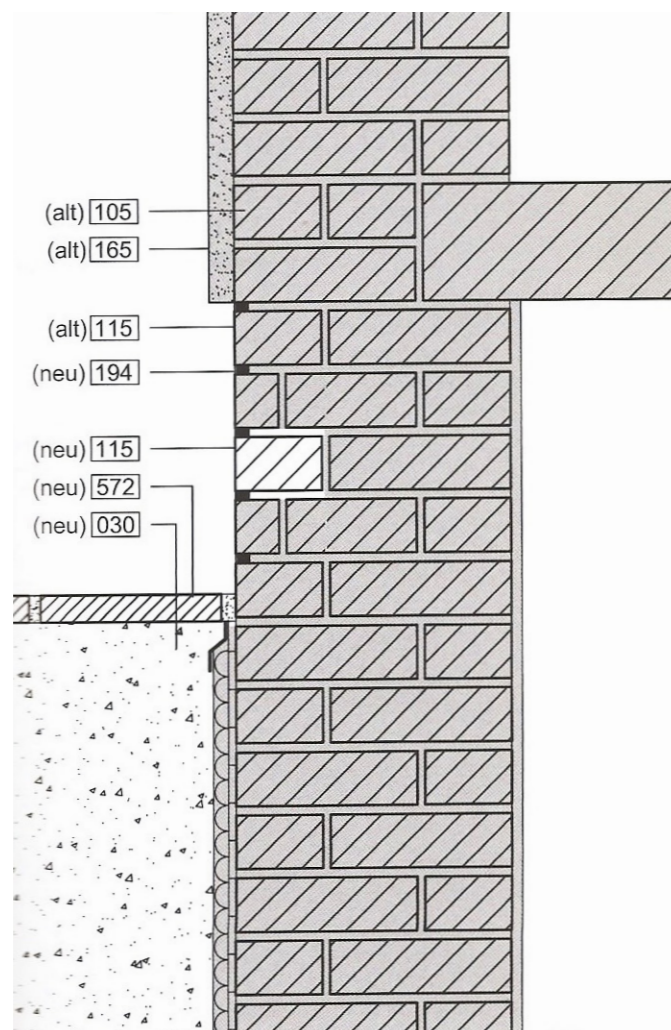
Detail Sanierung des Gebäudesockels M 1:10
